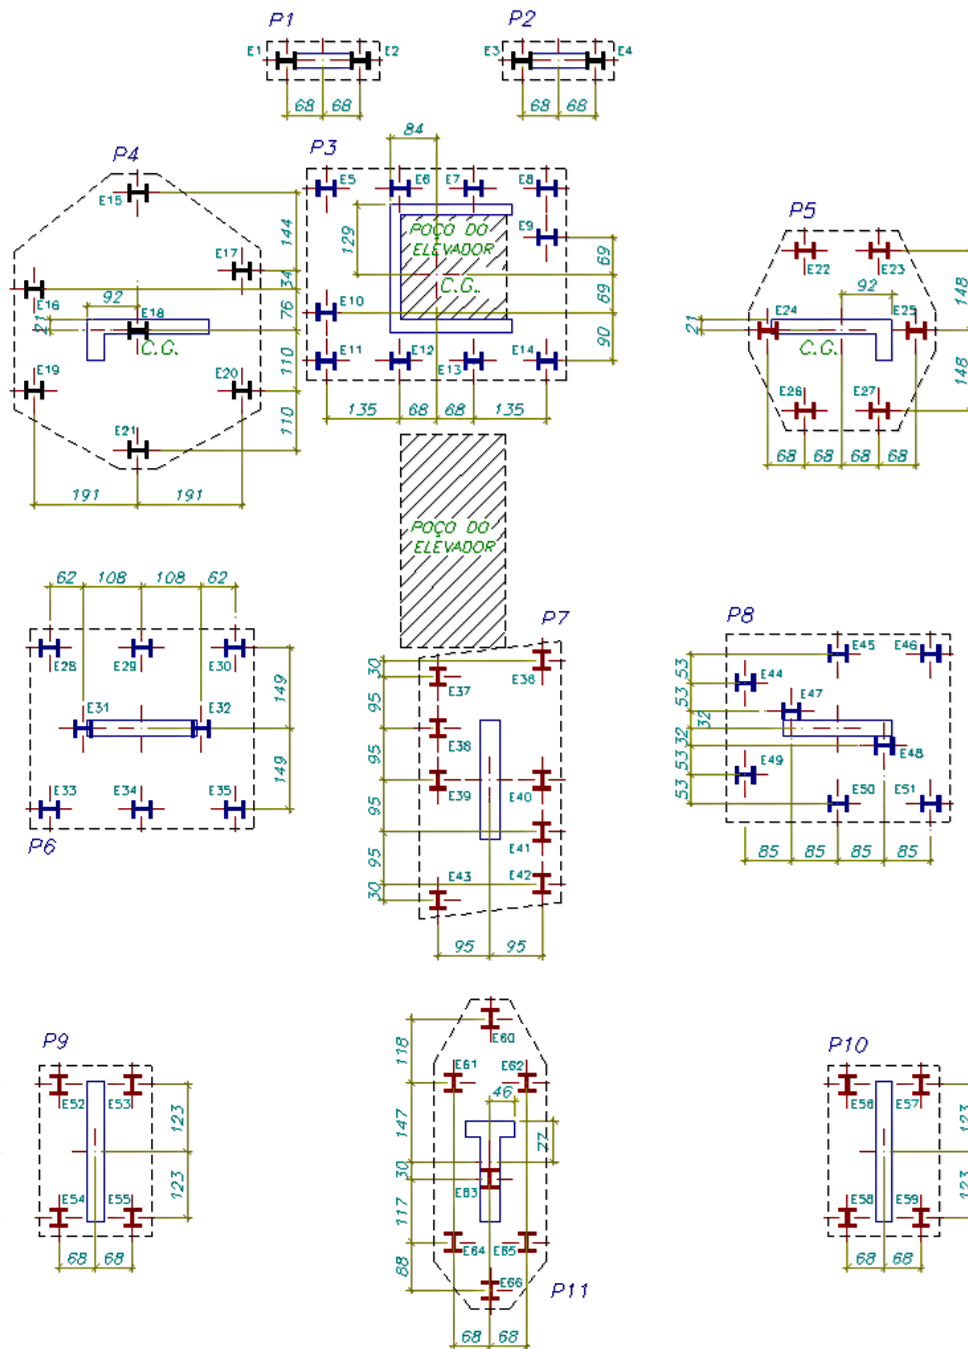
Planta de fundação (Estaqueamento) - Edifício 2
